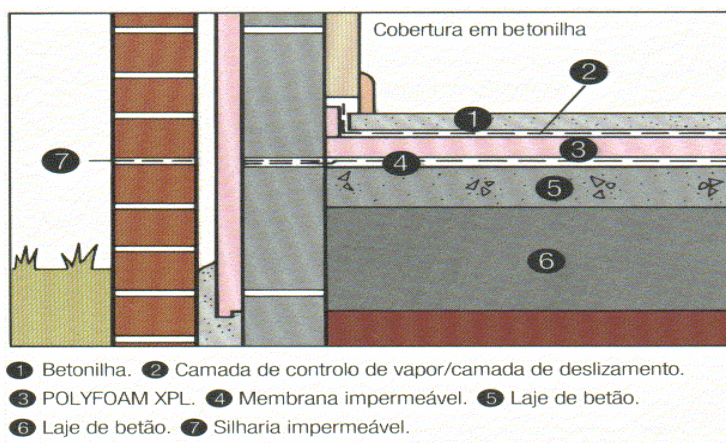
Pavimento térreo com isolamento térmico.
